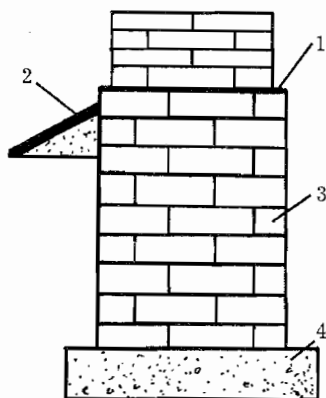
Кирпичный ленточный фундамент: 1 — горизонтальная гидроизоляция; 2 — отмостка; 3 — кирпичная кладка; 4 — монолитная фундаментная плита.
